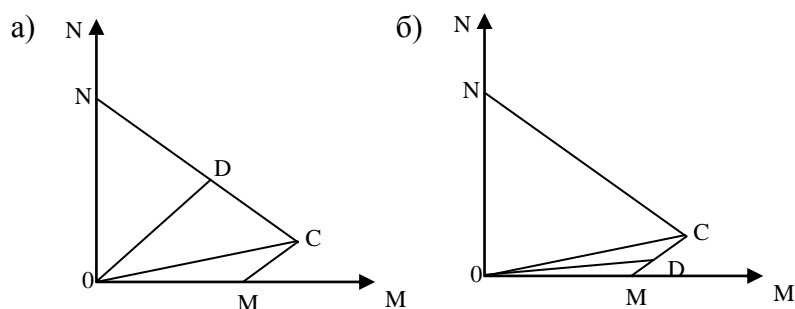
Розрахункові випадки підбору перерізів сталобетонного елемента
